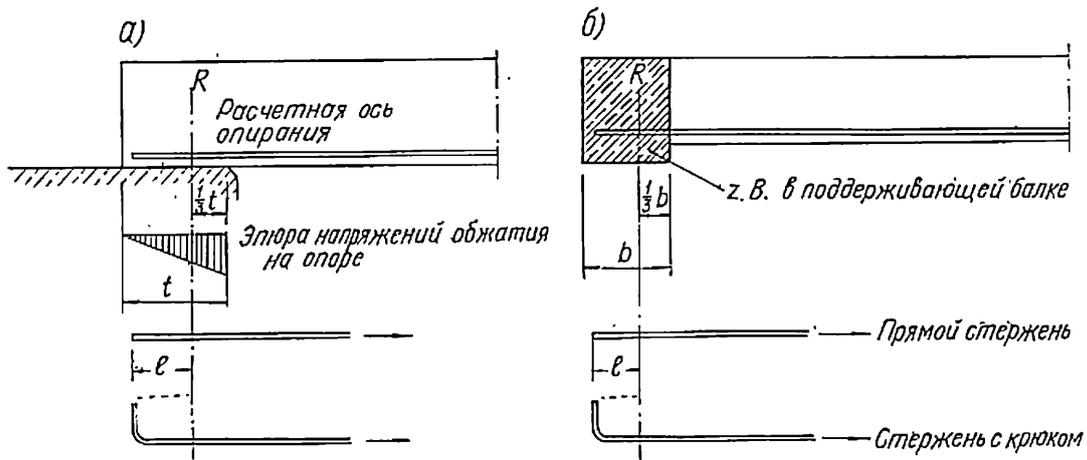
9. Длина заделки арматуры на концевой опоре
